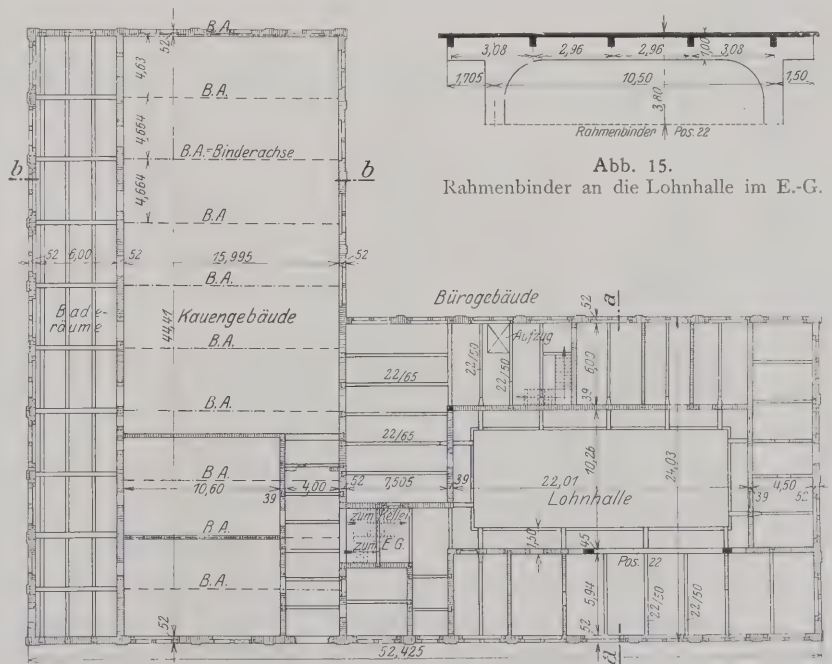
Grundriß in Höhe der Erdgeschoßdecke.
